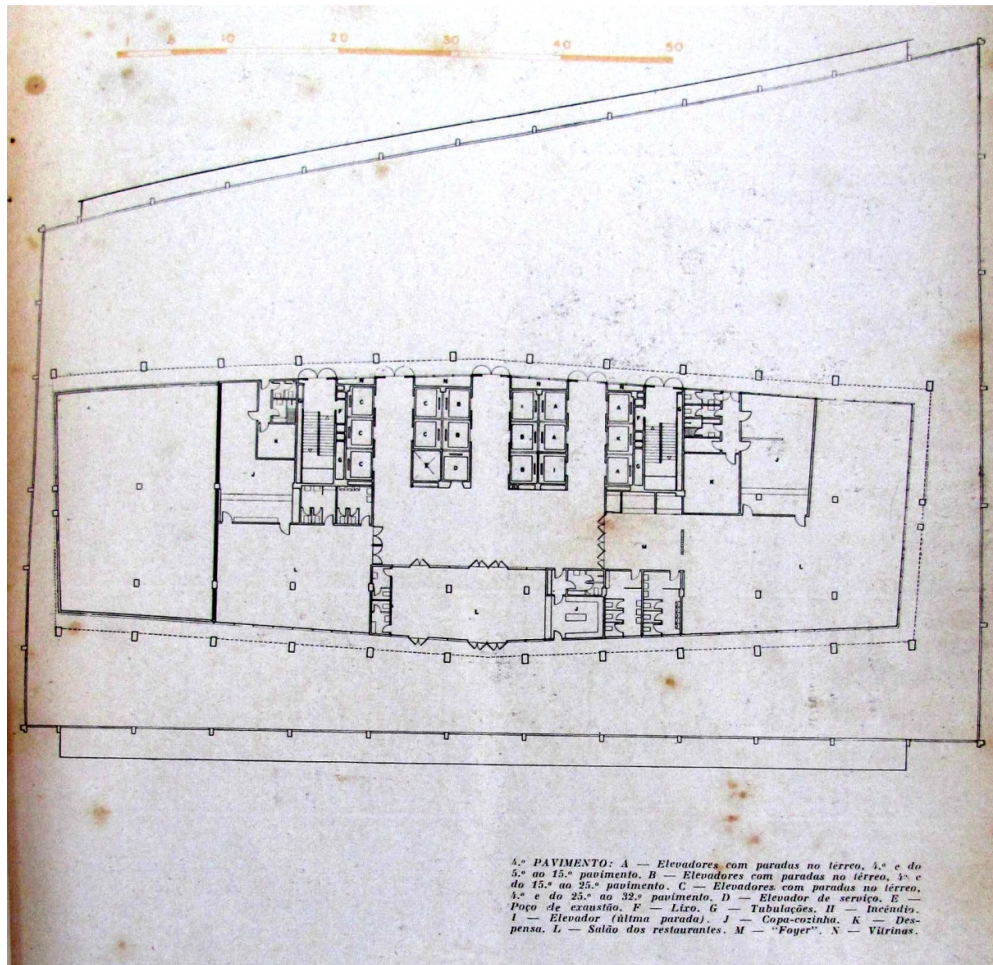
F – Planta baixa do 4º pavimento do bloco base, ainda sem o restaurante (desenho com deformações devido a limitações de reprodução)
